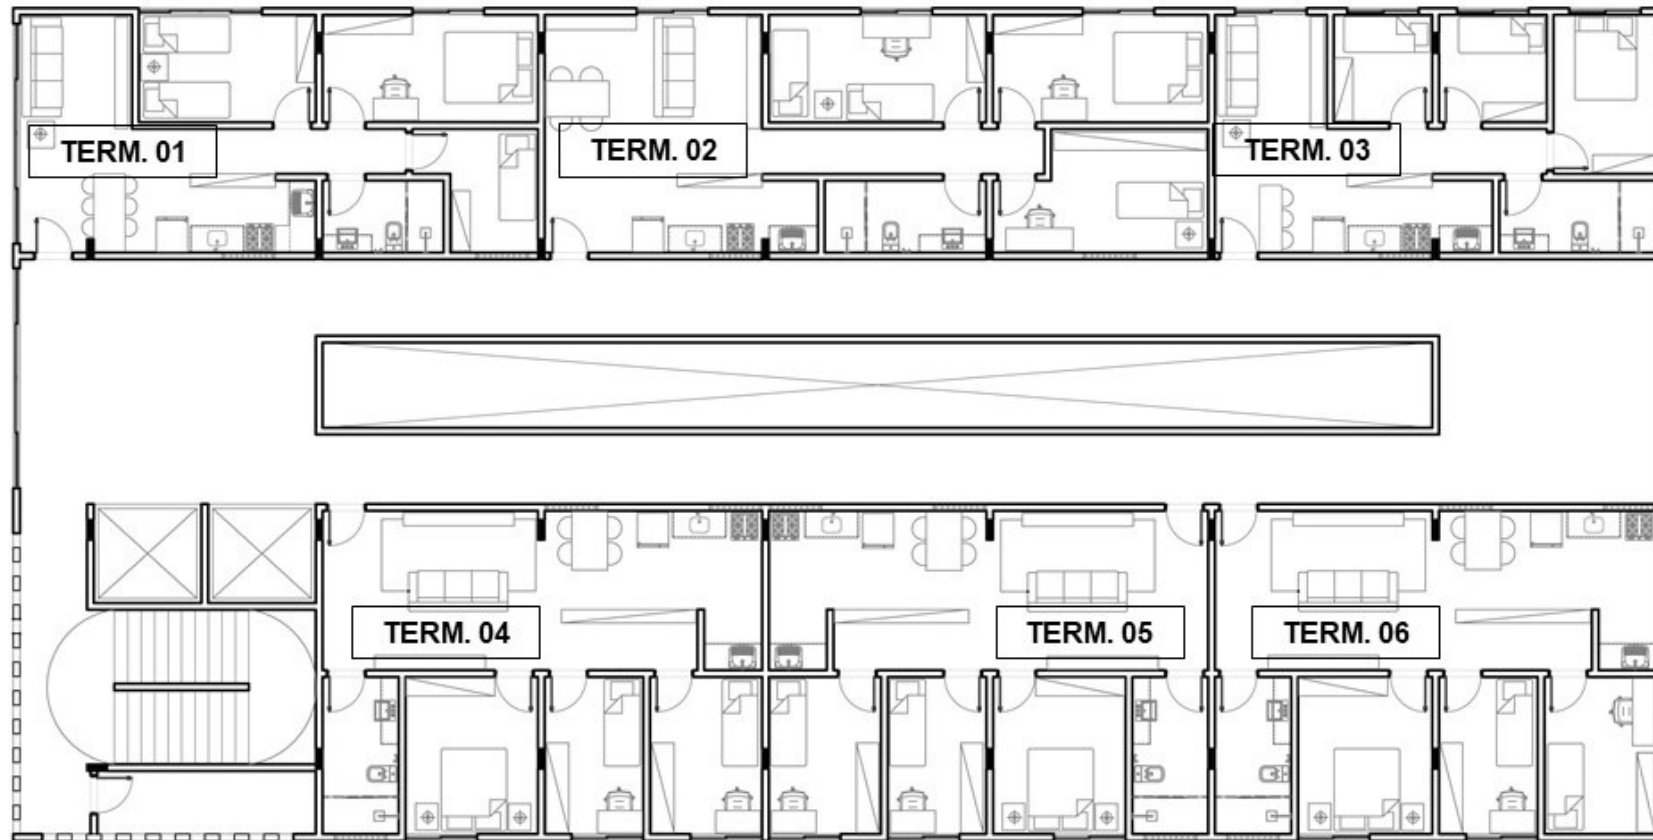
Planta Baixa Pavimento Tipo – Proposta.
